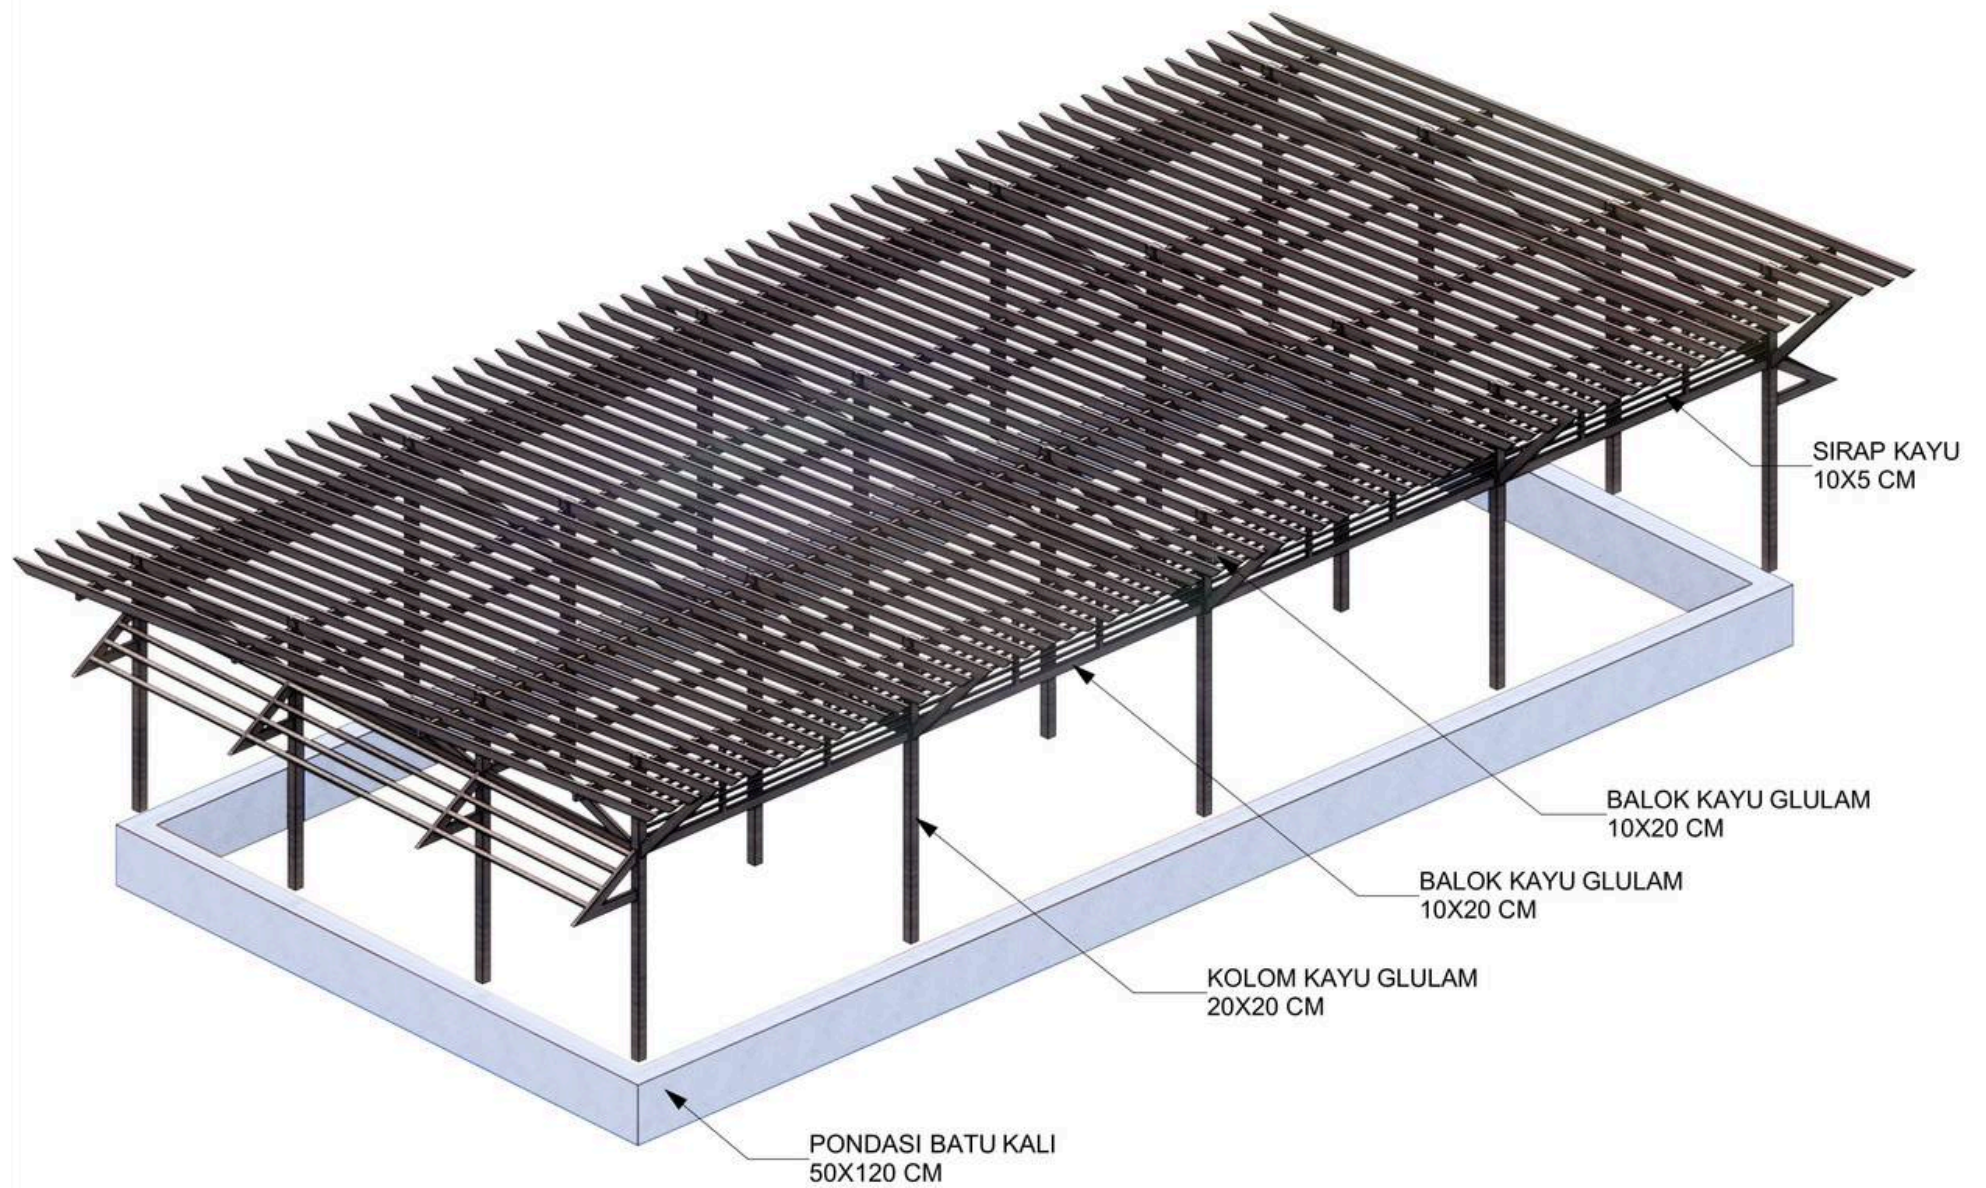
Struktur bentuk bangunan tipe A
